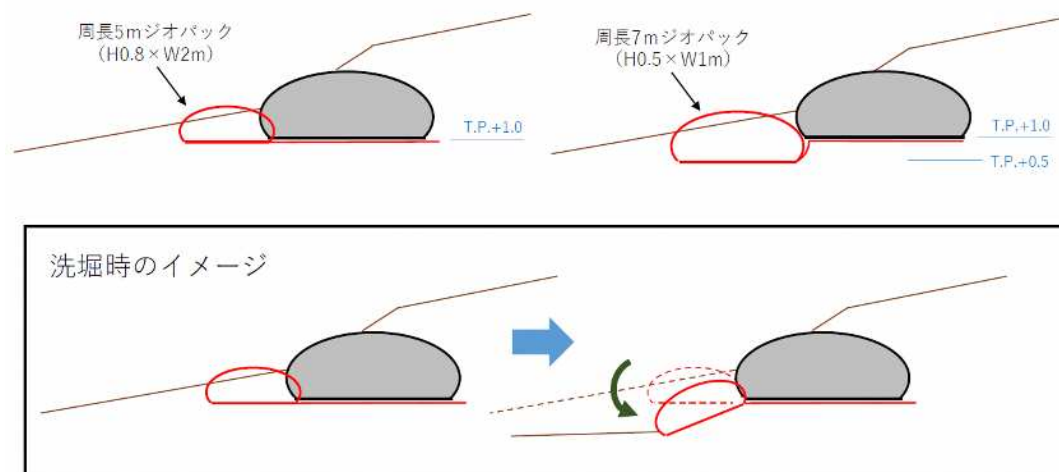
参考：試験施工① 洗堀対策と養浜量低減を考慮した断面形状
